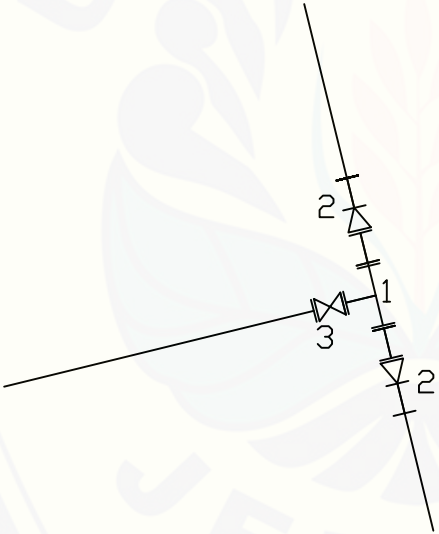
DETAIL SAMBUNGAN PIPA (PER 6 METER)
